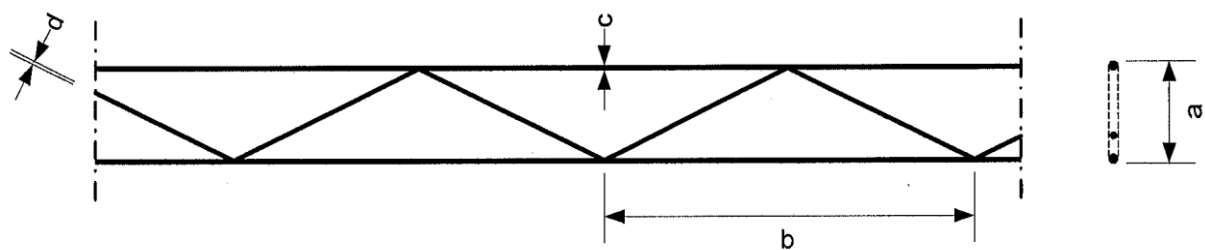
Армирование перемычек заводского изготовления из ячеистого бетона для стен из ячеистобетонных блоков [25]
